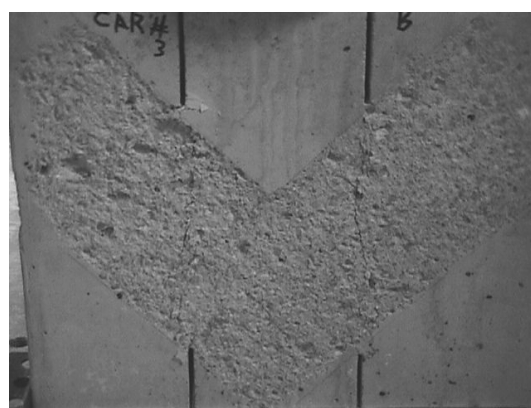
Tanto en esta figura como en la B3 se pueden ver las fisuras generadas que van de las entallas superiores a las inferiores.
